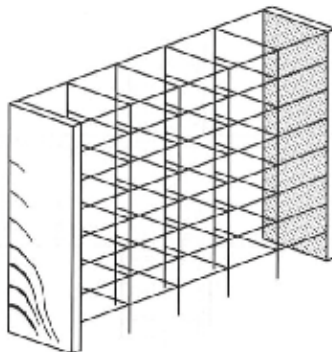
Fisuración de pantallas continuas de corte (Fuente: Calavera, 2005)
